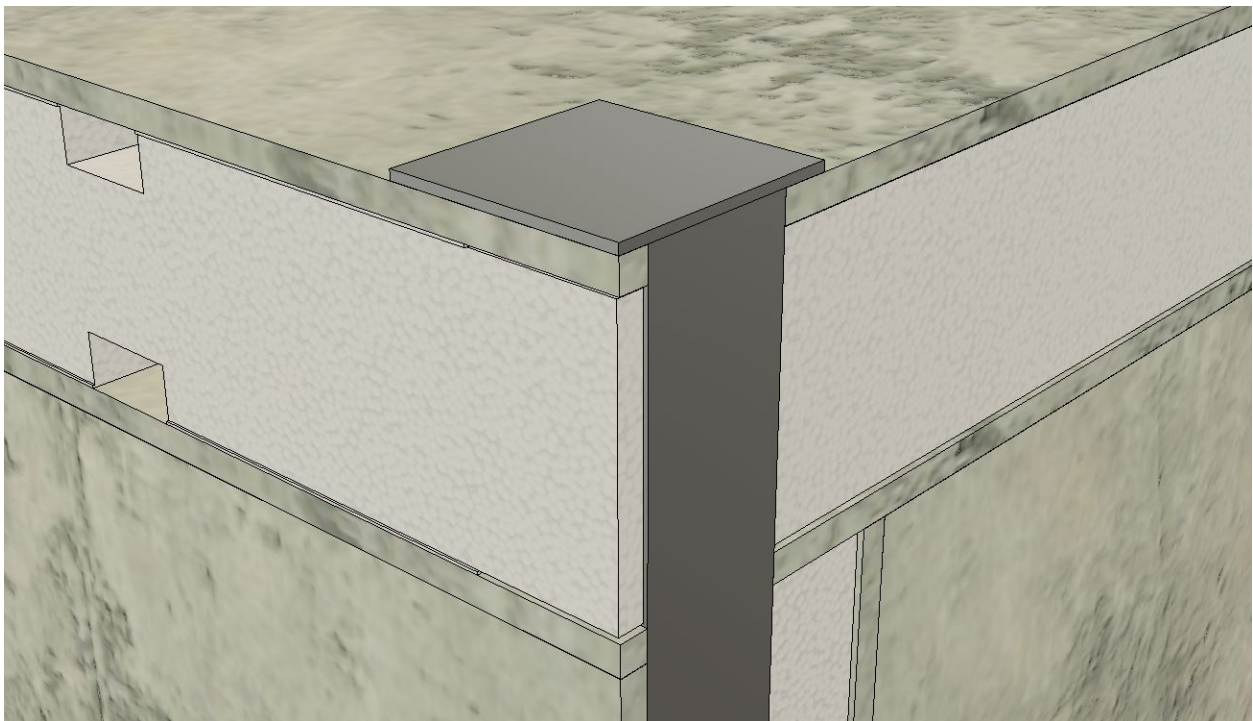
Preparación para acoplamiento con módulo de segunda planta.
